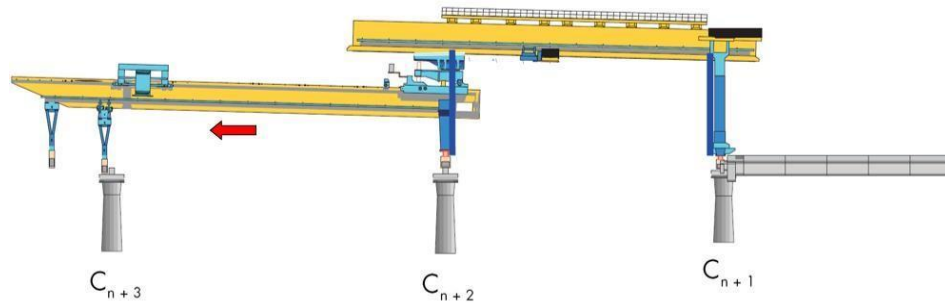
Fase 3: avance de la viga inferior. Viga lanzadora lista para nuevo vano
